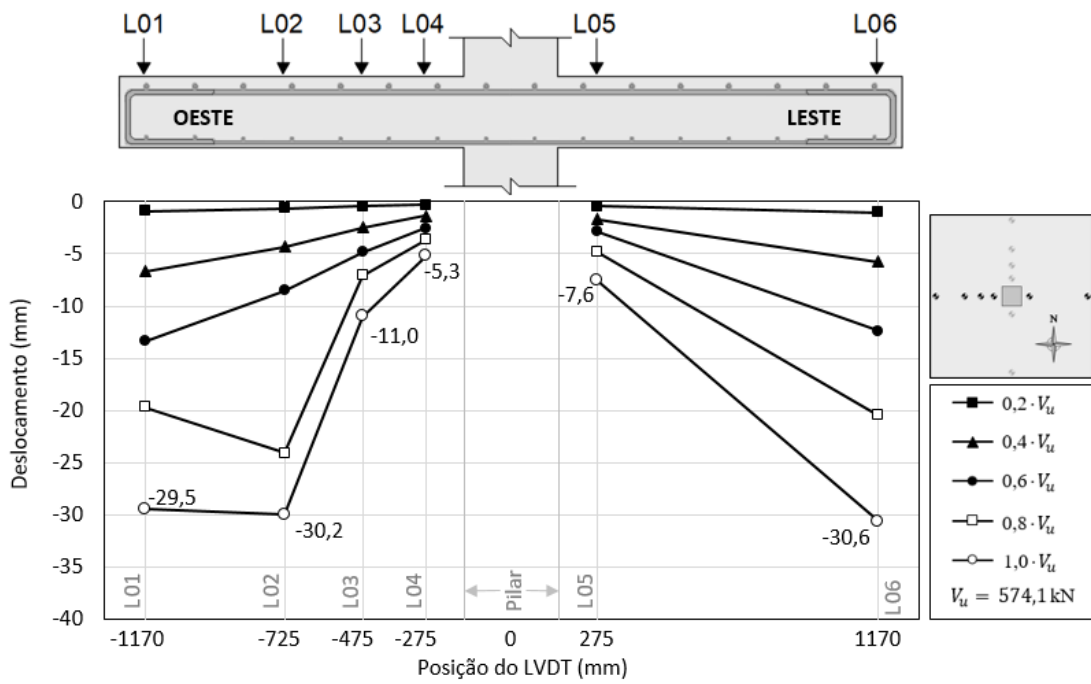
Deslocamentos verticais na direção Leste-Oeste para a laje TA-05
